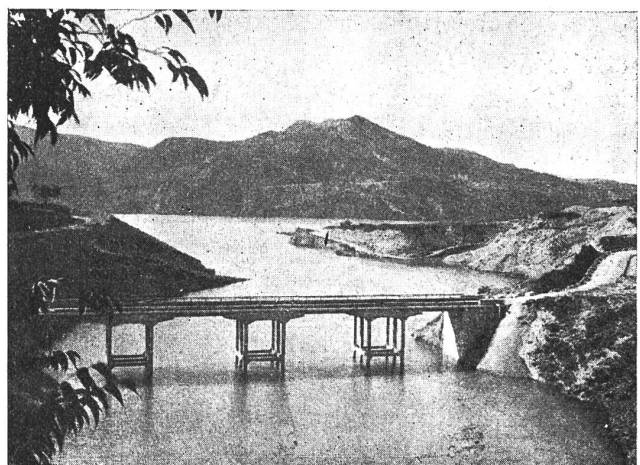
Blick aus einem Seitenarm auf den Stausee. Im Vordergrund neue Strassenbrücke im Zuge der verlegten Staatsstrasse Tresp-Pobla-Frankreich.
